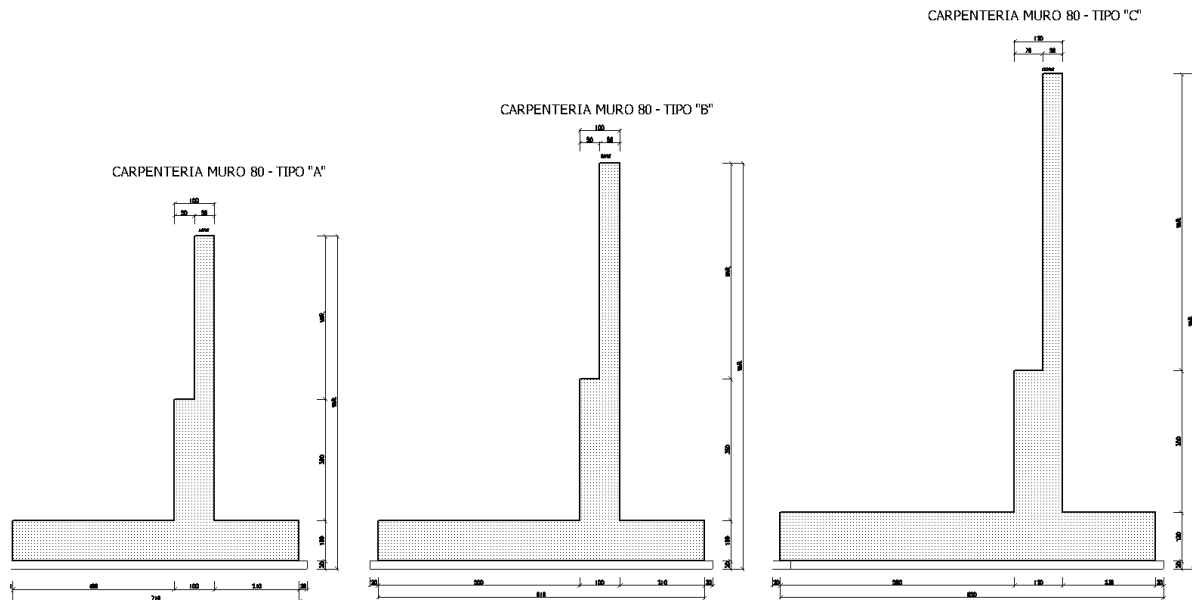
Sezioni trasversali Tipo A Tipo B e Tipo C
